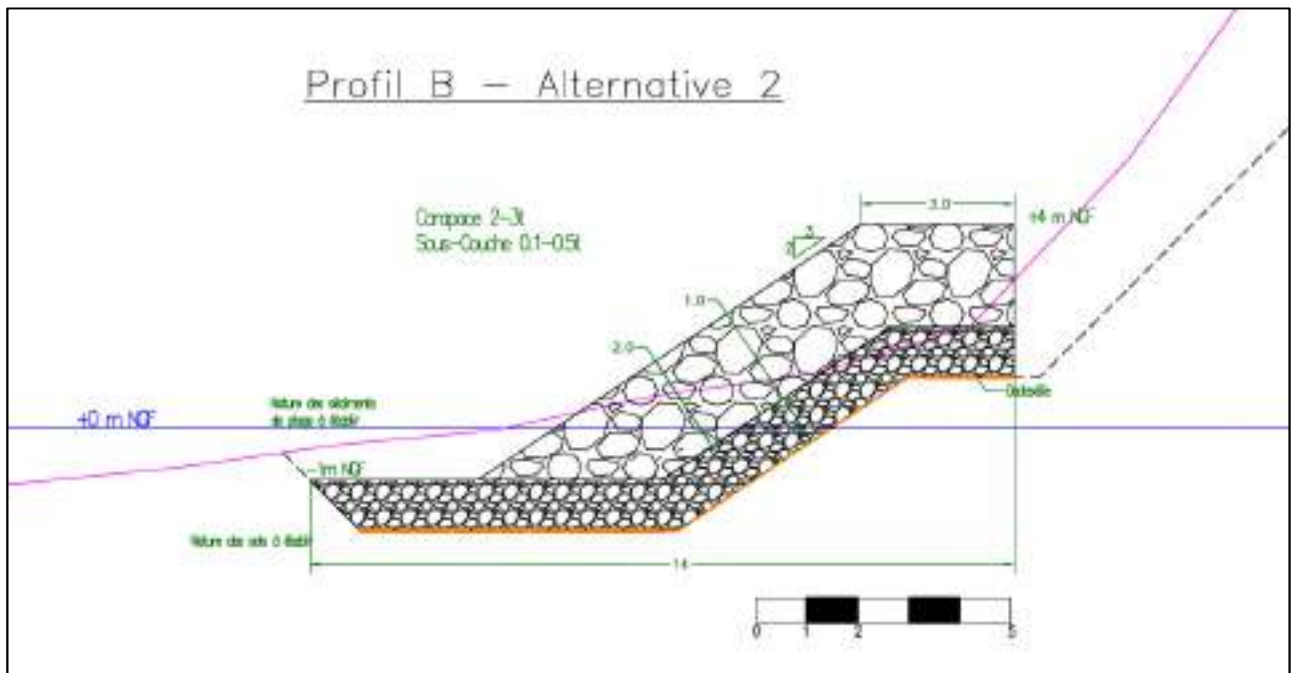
coupe de principe de l'alternative 2 au niveau du profil B
